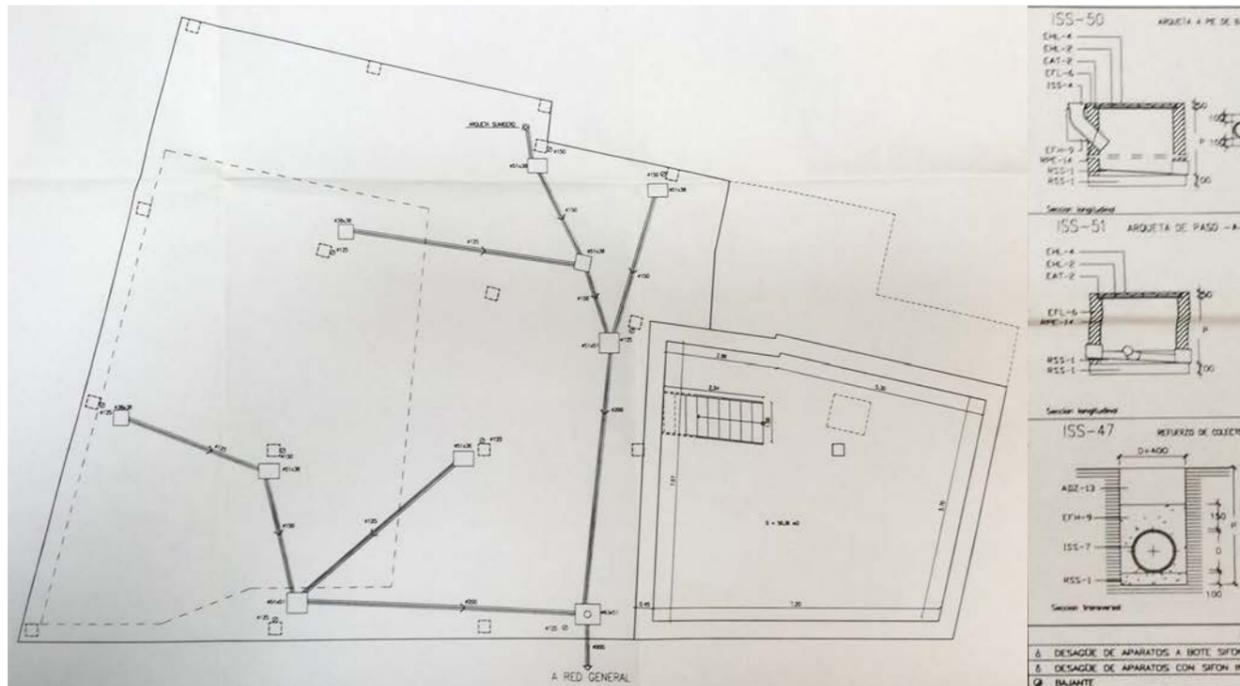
Proyecto Básico 1997. Plano saneamiento planta sótano.
